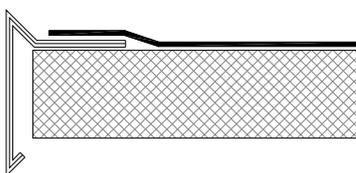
Dachrandabschluss mit Verbundblechprofil
